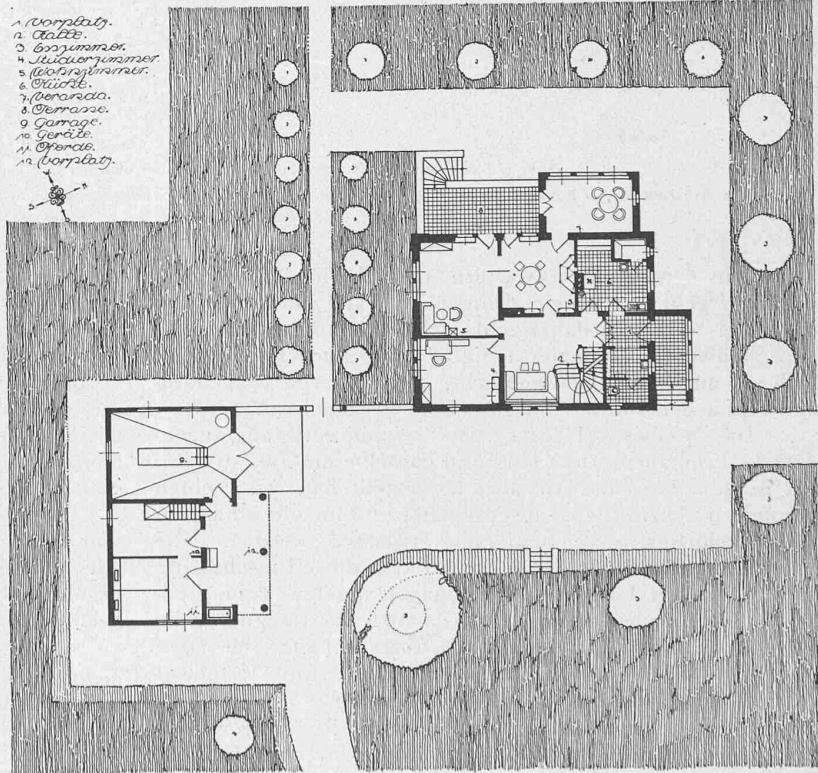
Erdgeschoss-Grundriss mit nächster Umgebung. — 1:400.
